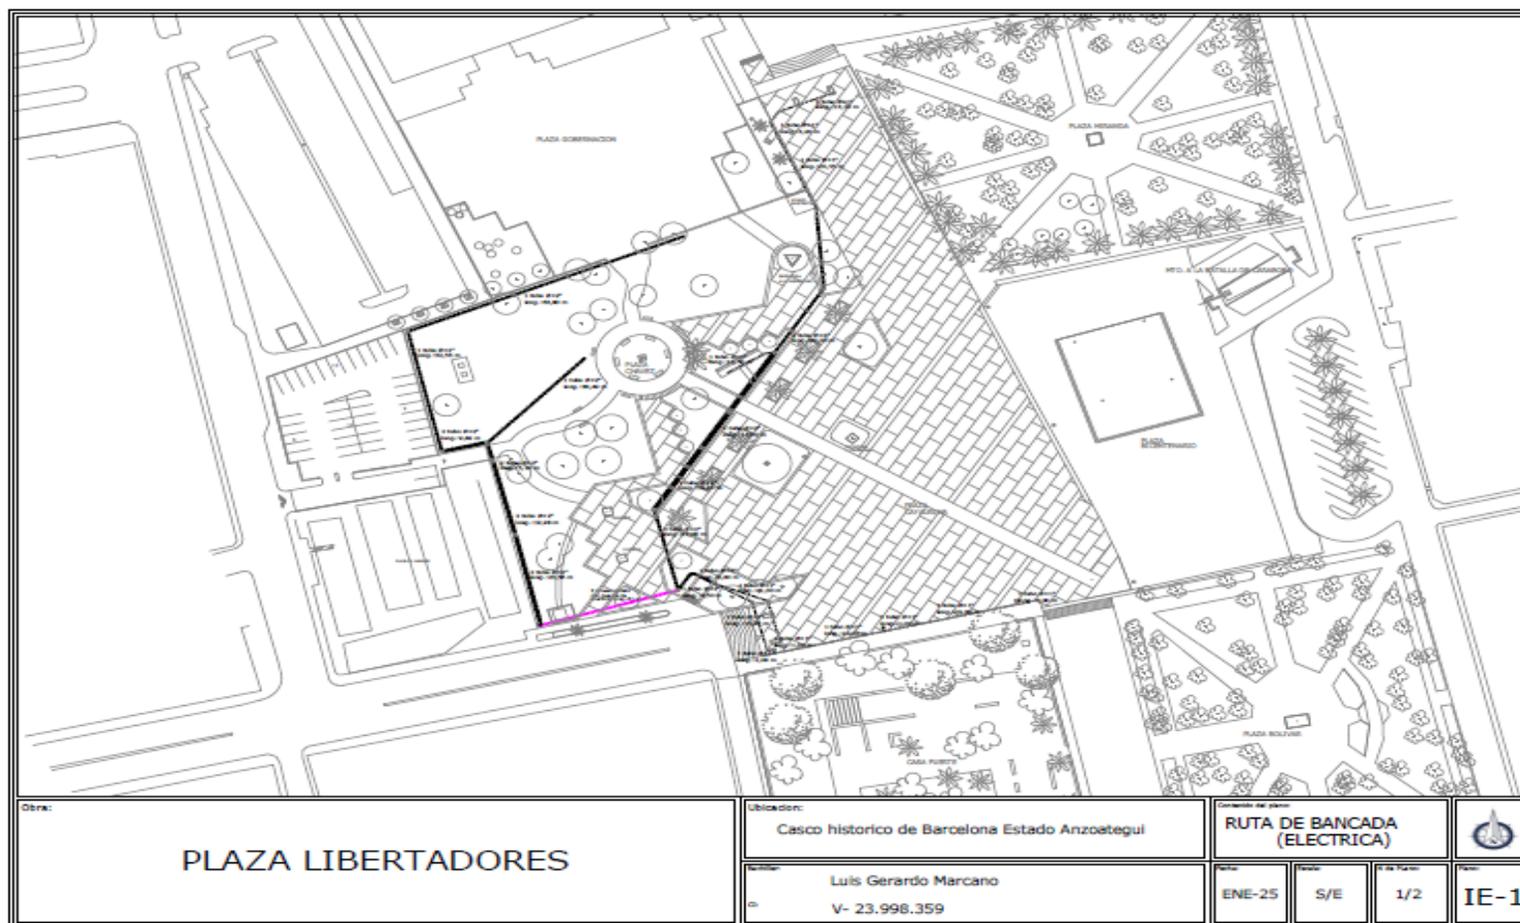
Plano propuesto del sistema eléctrico. Ruta de Bancada. Fuente: Elaboración propia (2024).
